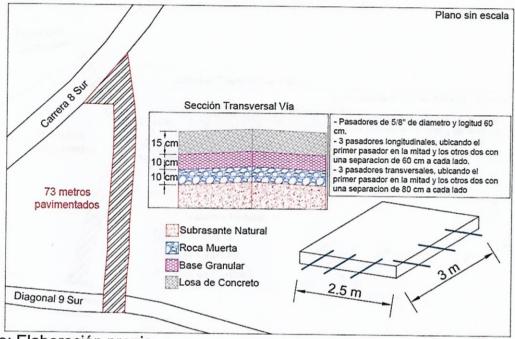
Plano y sección transversal carrera 8 entre calles 1 y 3 sur
